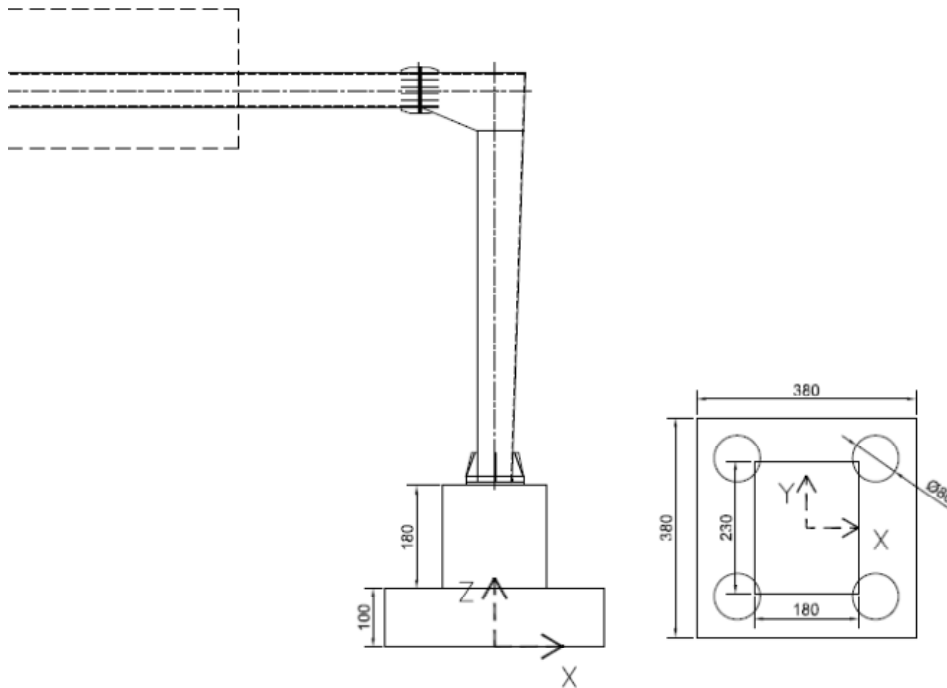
Carpenteria del plinto di fondazione - Posa su terreno pianeggiante
